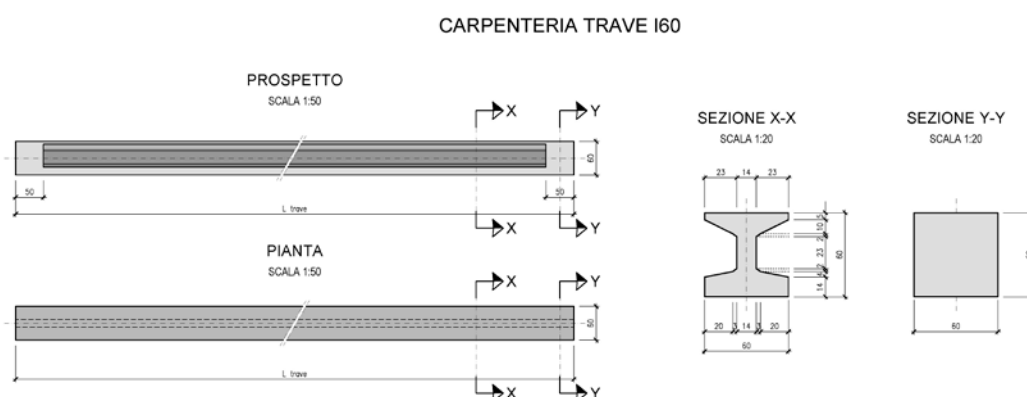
Impalcato 7 – Particolare travi a doppio “T”
